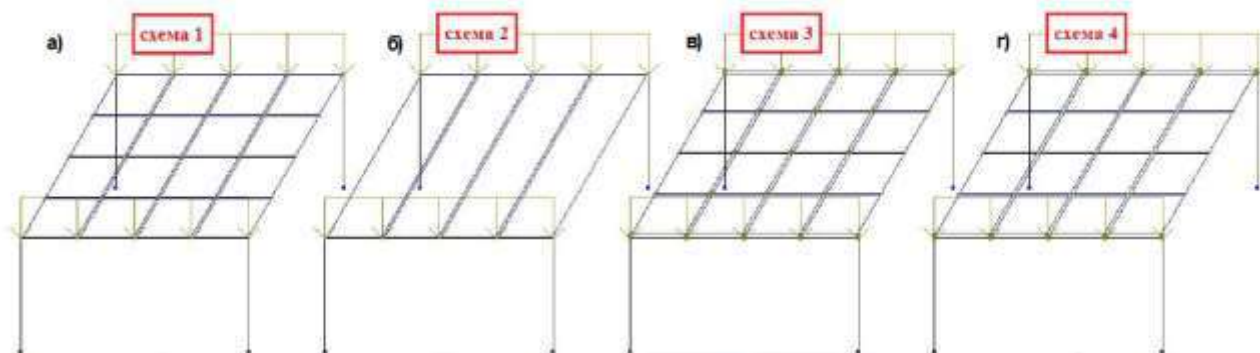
Способи моделювання збірних перекриттів: схема 1-перекриття-оболонка; 2 схема-перекриття балка-стінка; 3-оболонка по грані плит (об'єднання переміщень X та Y); 4- перекриття-оболонка (KE 55)
